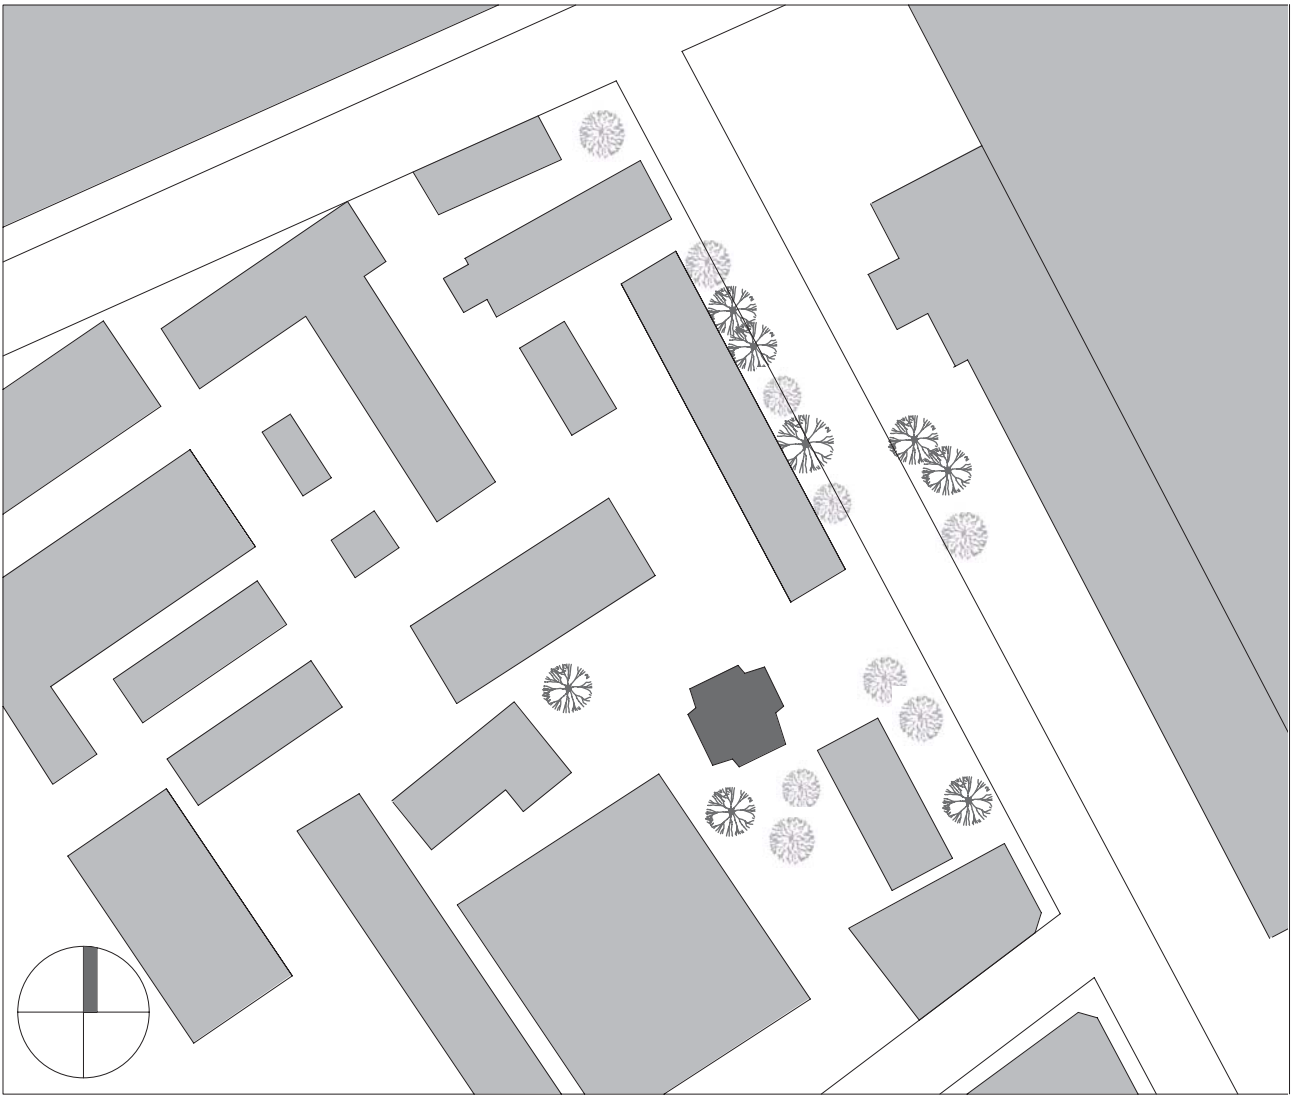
Lageplan (dunkelgrau das Fallbeispiel Gebäude B)
